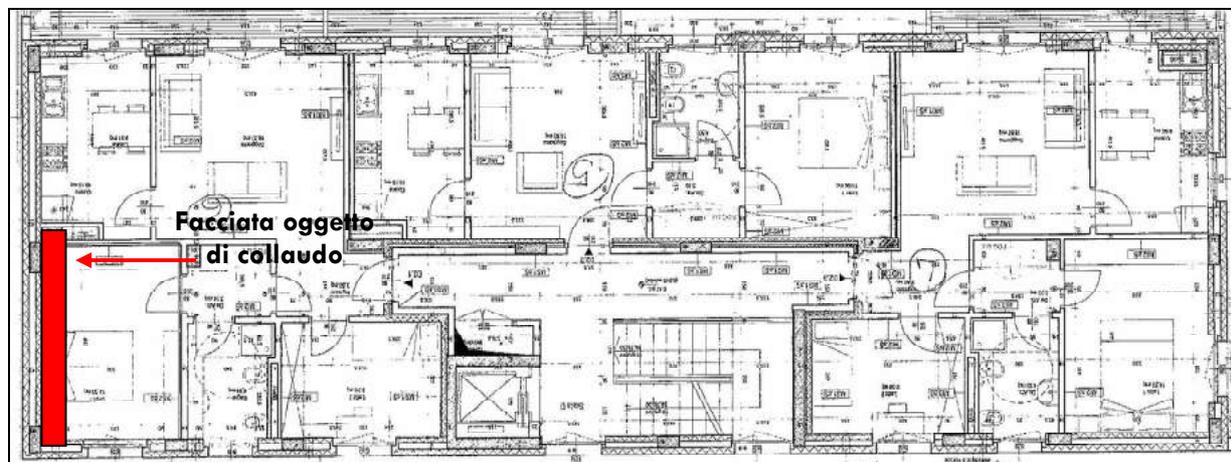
Progetto architettonico: pianta piano secondo ed indicazione paramento collaudato
